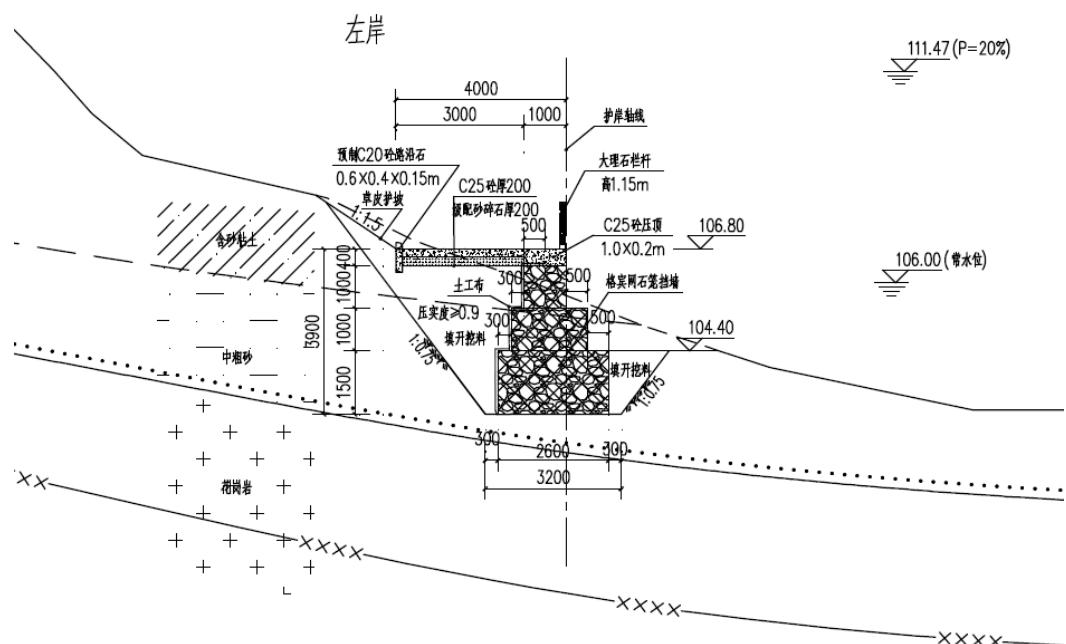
格宾网笼结构+草皮护岸典型剖面图
